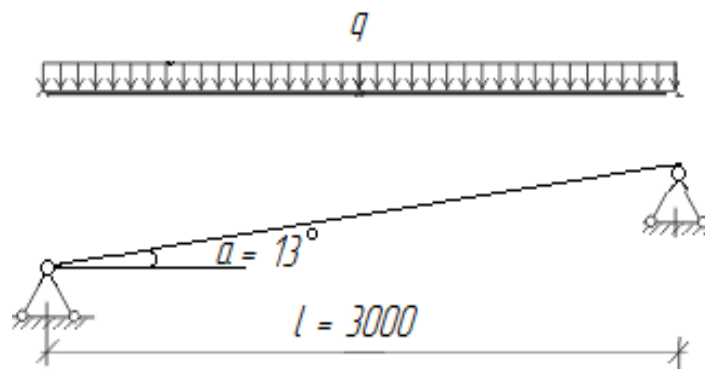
Расчетная схема однопролётной стропильной ноги
